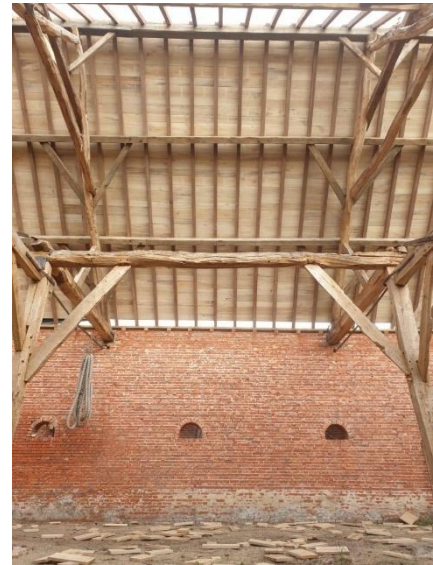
Montage systeem zijaanzicht (Eigen foto, 2025)
